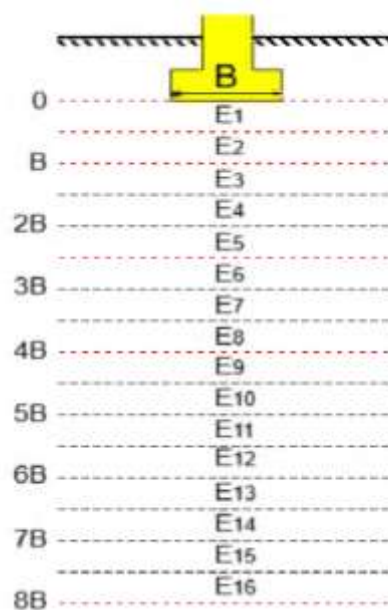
Modules pressiométriques à considérer pour le calcul du tassement d'une fondation
